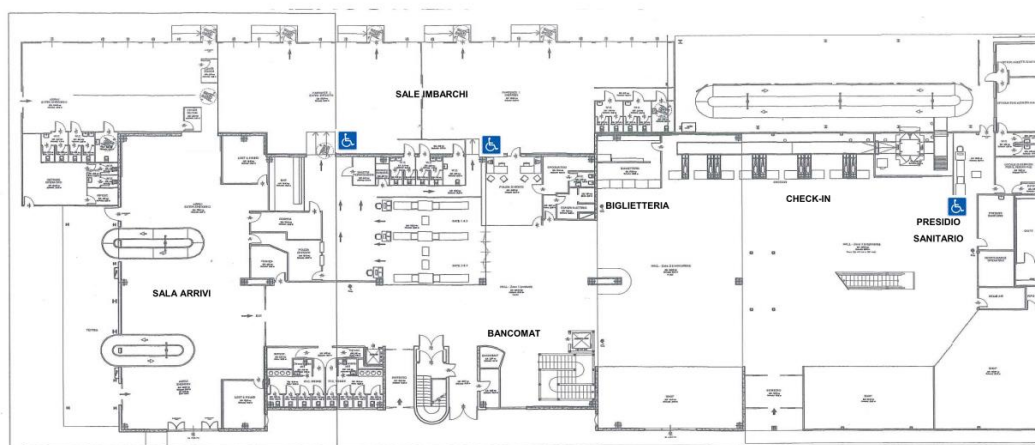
Configurazione fisica attuale: aerostazione passeggeri, planimetria piano terra
